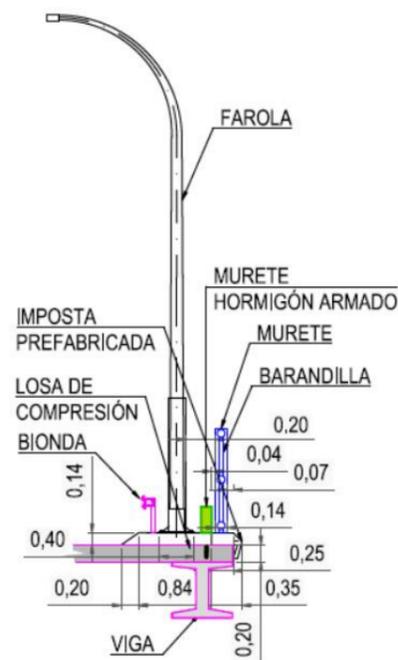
Disposición del Murete aguas arriba del puente de la autovía MA-21.
